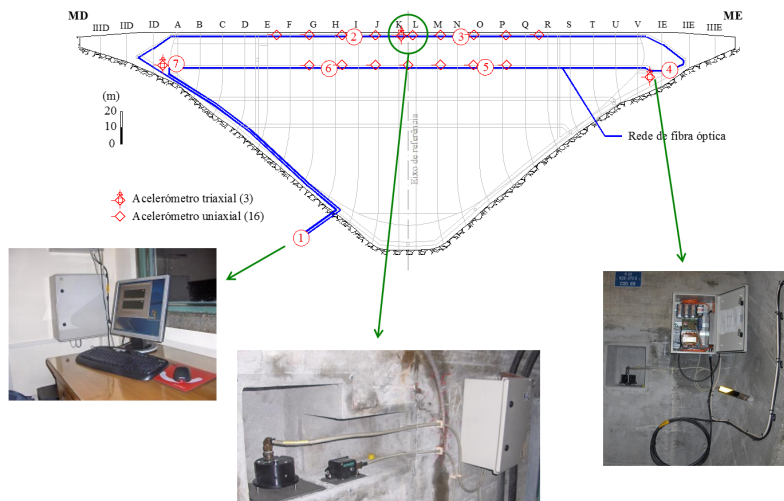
Sistema SSHM instalado na barragem do Cabril, em 2008
